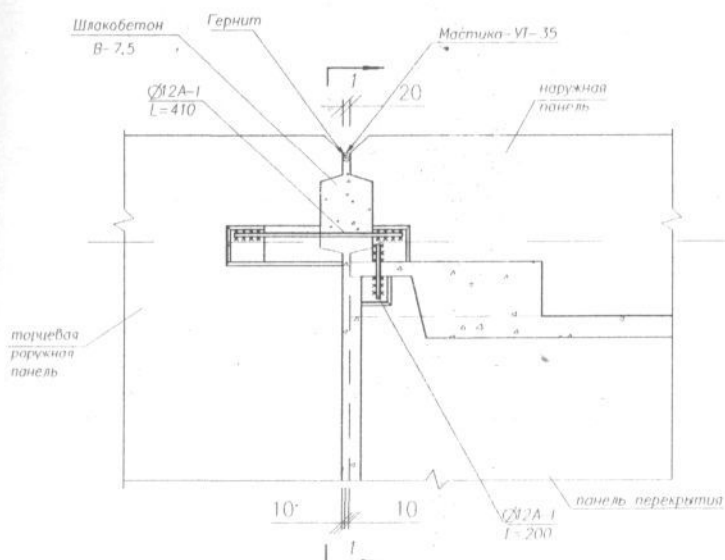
Стык торцевых наружных панелей и панелей перекрытия
